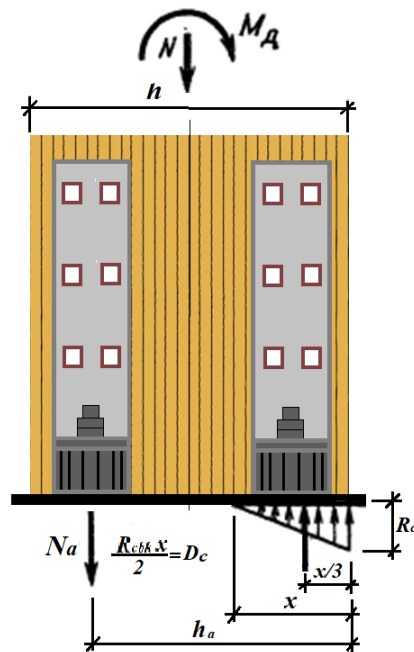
Схема к расчету узла заземления колонны в фундаменте
